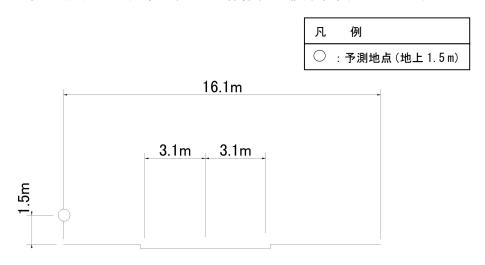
(5) 予測断面図(E.主要地方道伊那生田飯田線沿道(伊那市東春近 8290 地先))
